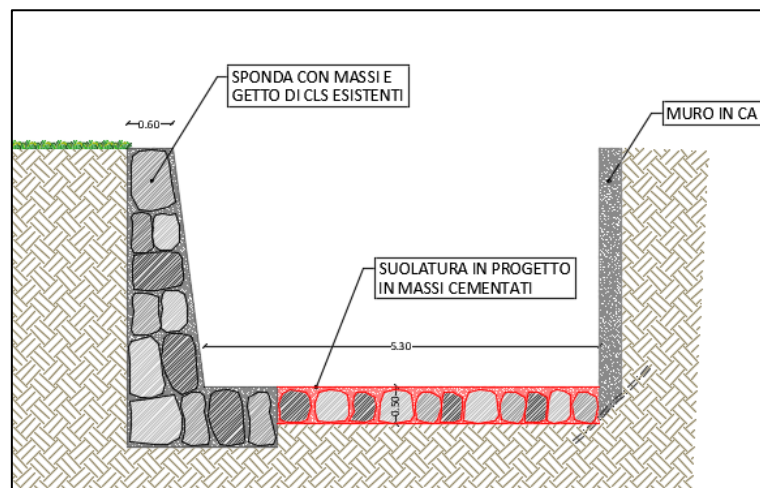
Sezione tipo suolatura alveo Rio Morto nel Tratto 4.
